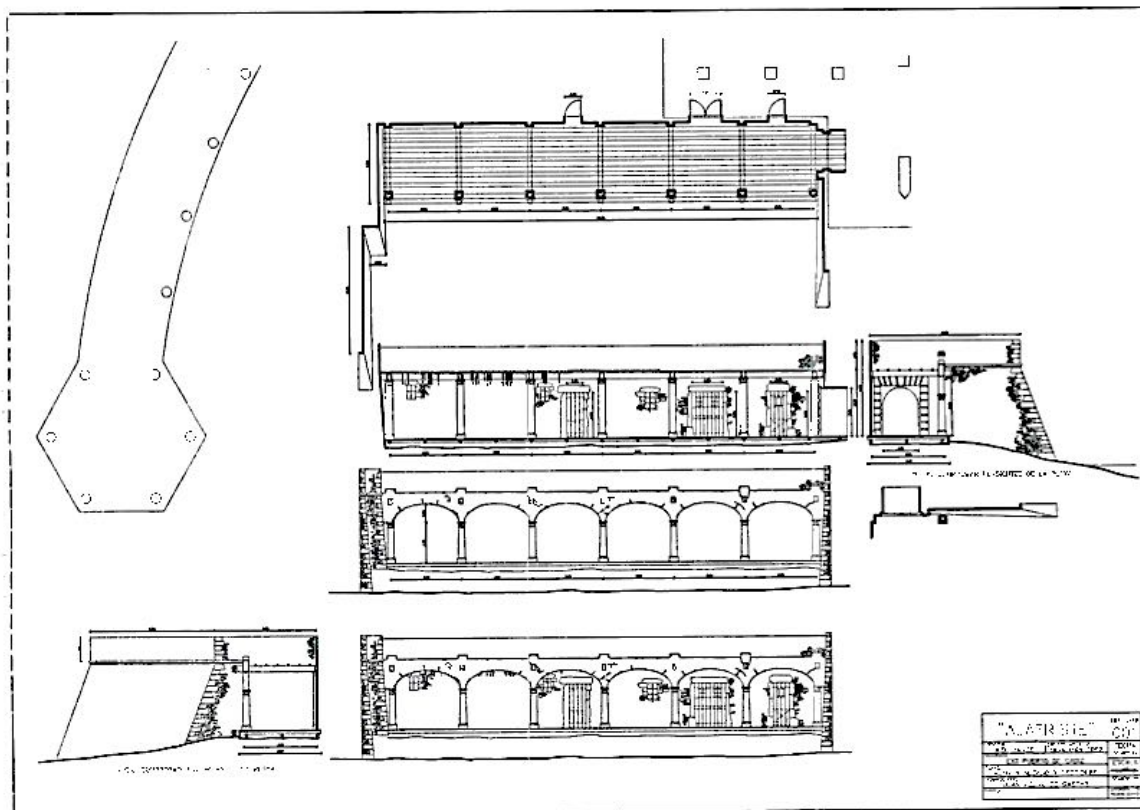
Plano. Planta del puerto de Cádiz. Playa la Caleta. Cádiz. *Alatriste*.
